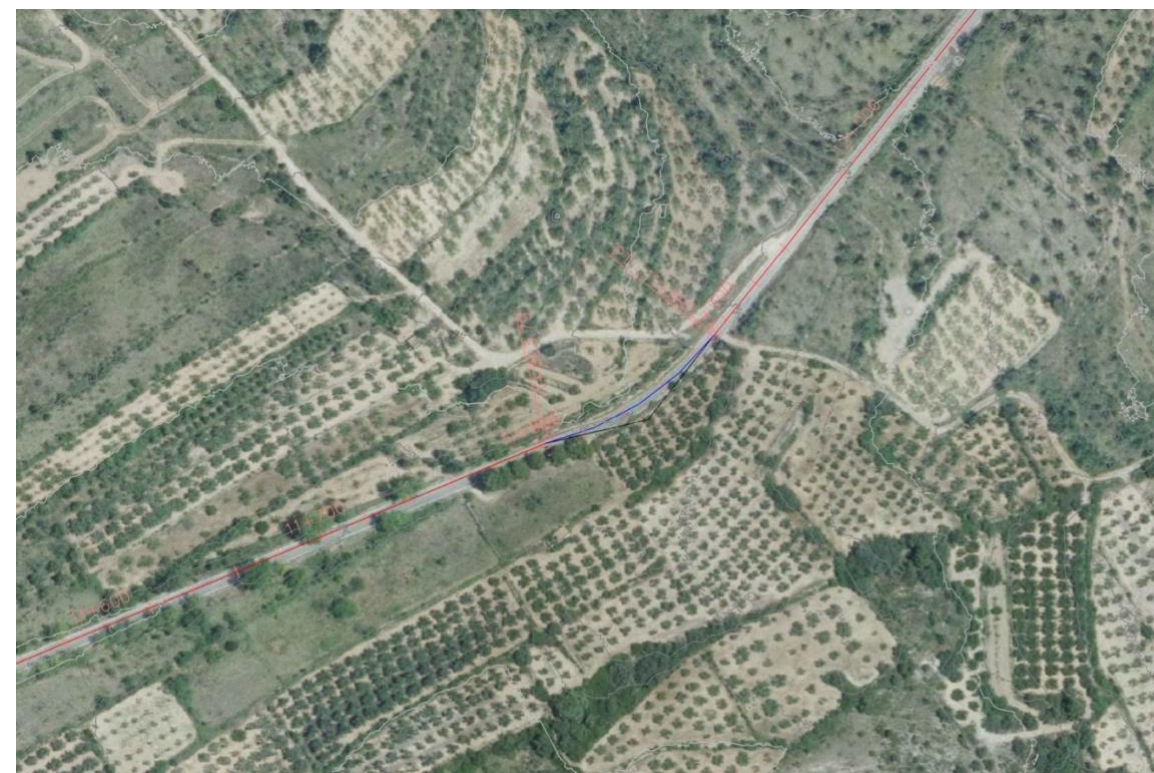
Pantallazo de Civil 3D con ortofoto y trazado de la carretera en planta (Curva 1)
